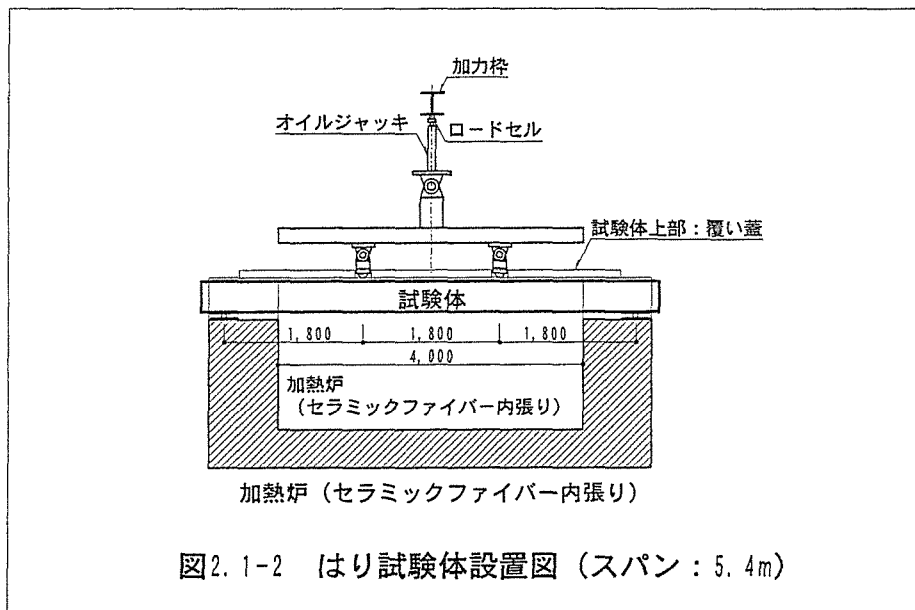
はり試験体設置図 (スパン：5.4 m)
